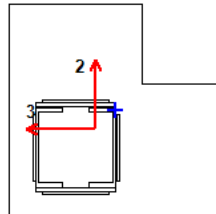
Capacidad de Columnas de la Capilla con columnas de sección mixta.
